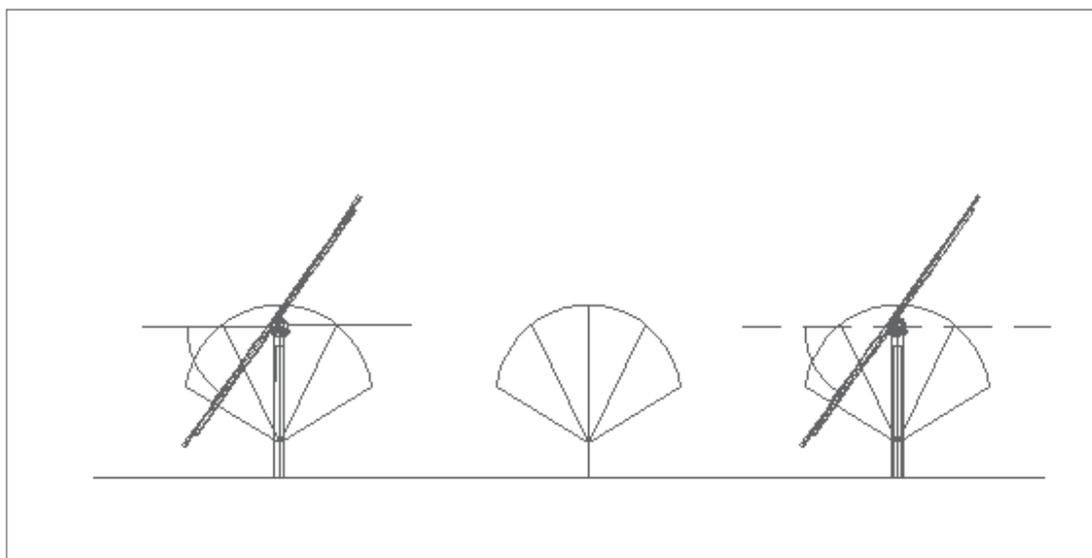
Sezione Trasversale_Sovrapposizione oliveto e impianto fotovoltaico oggetto di investimento
